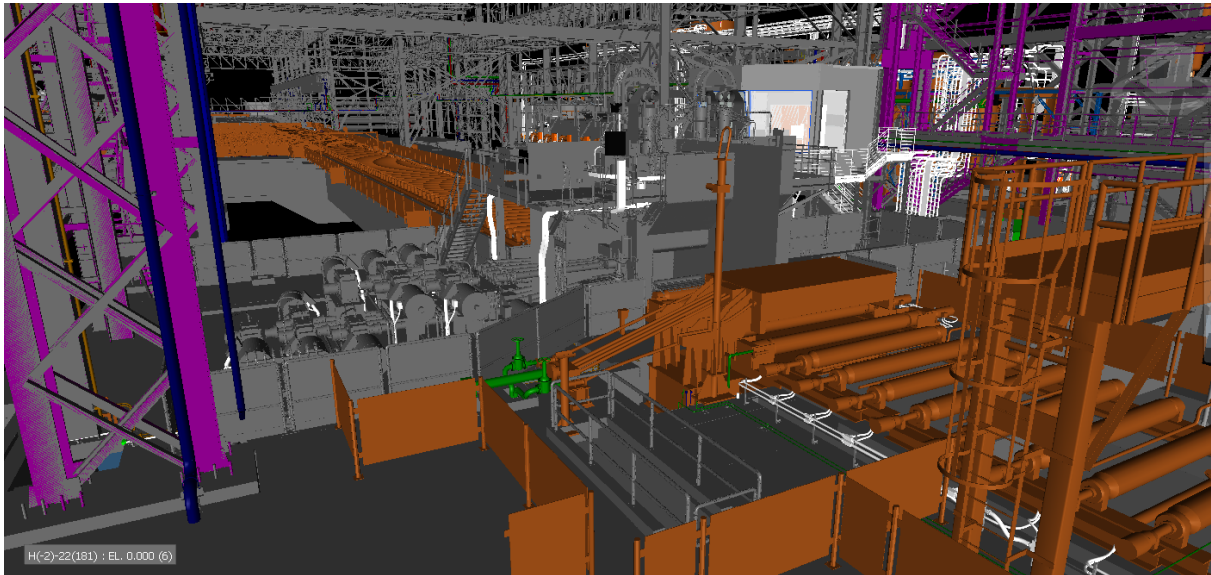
Modelos interdisciplinares (Tubulações, Equipamentos Mecânicos, Estrutura Metálica e em Concreto Armado) integrados via Navisworks
